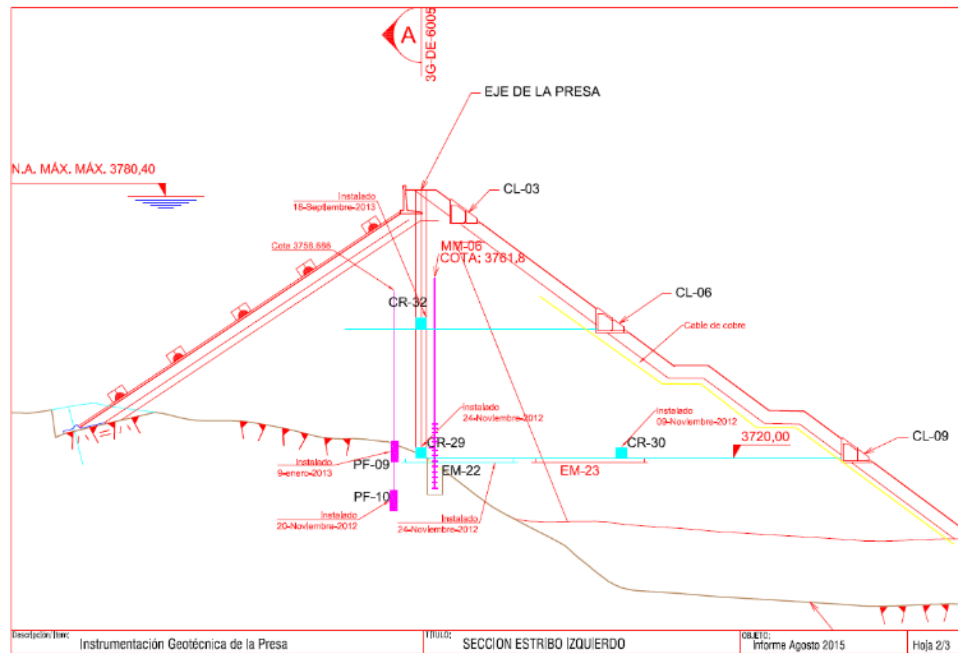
Sección estribo izquierdo de la presa con el detalle de los instrumentos instalados.
